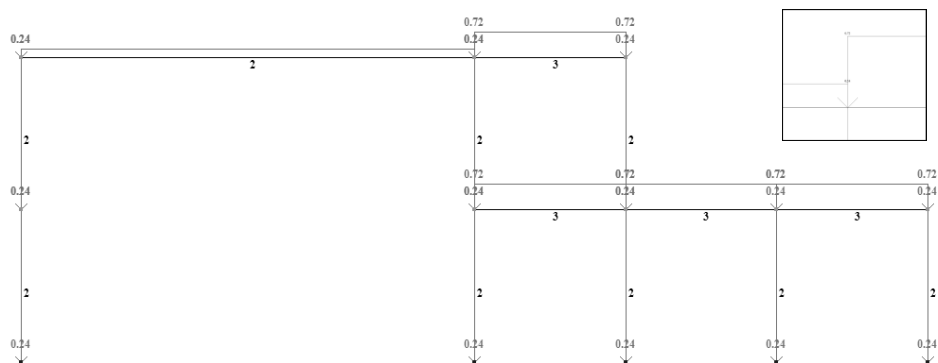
Схема загрузки рамы нагрузками от собственного веса элементов.
